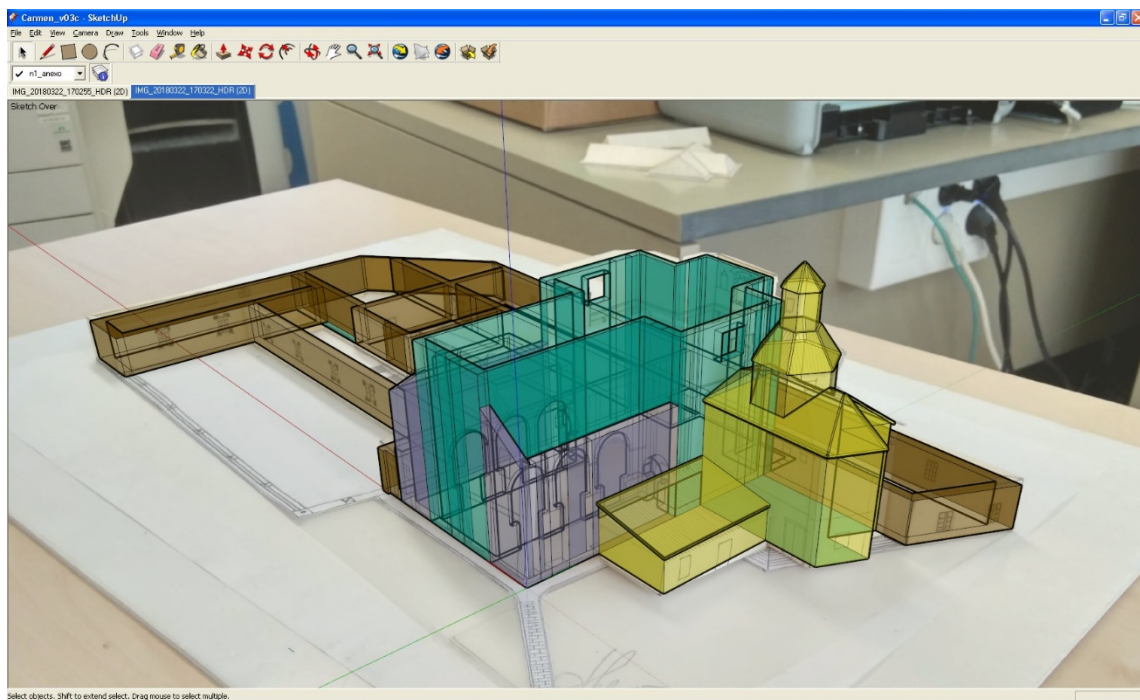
Modelado de los bloques que componen el montaje de la planta baja.
